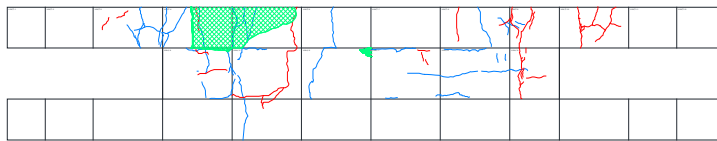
荷終了時点のひび割れ 耐力壁
